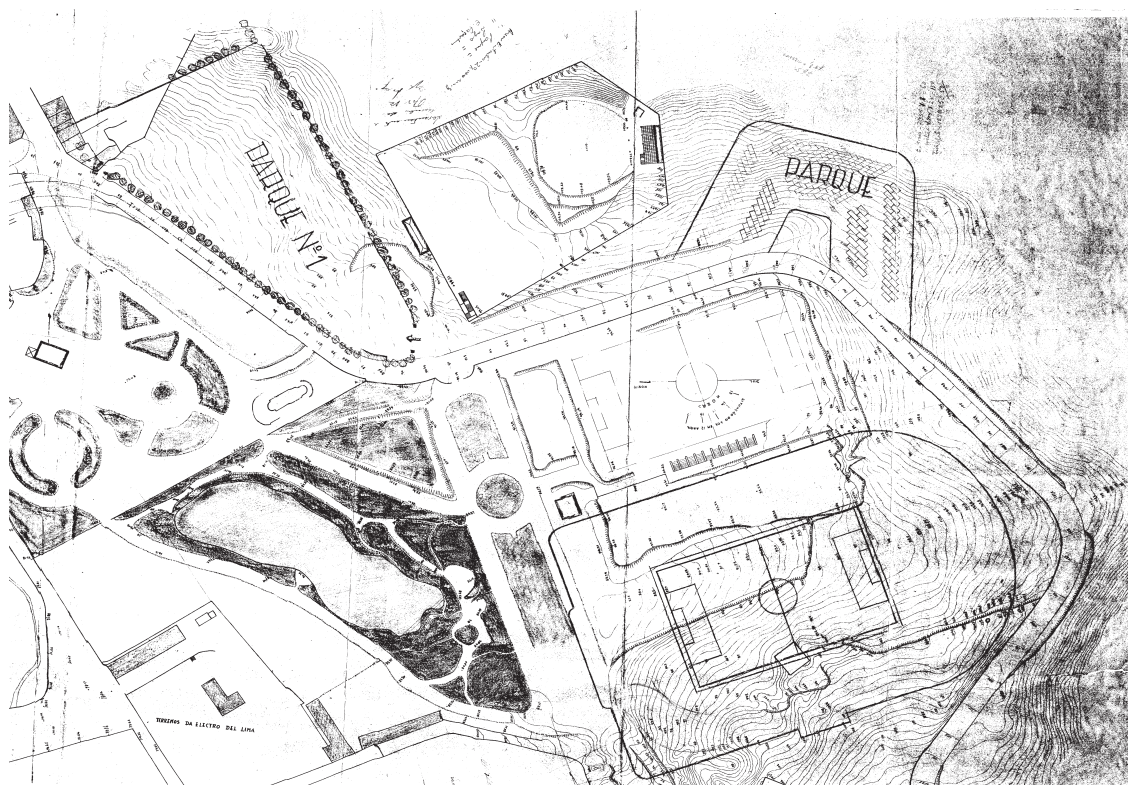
"Estádio 28 de Maio Braga" - planta de implantação, João Simões, 1946
